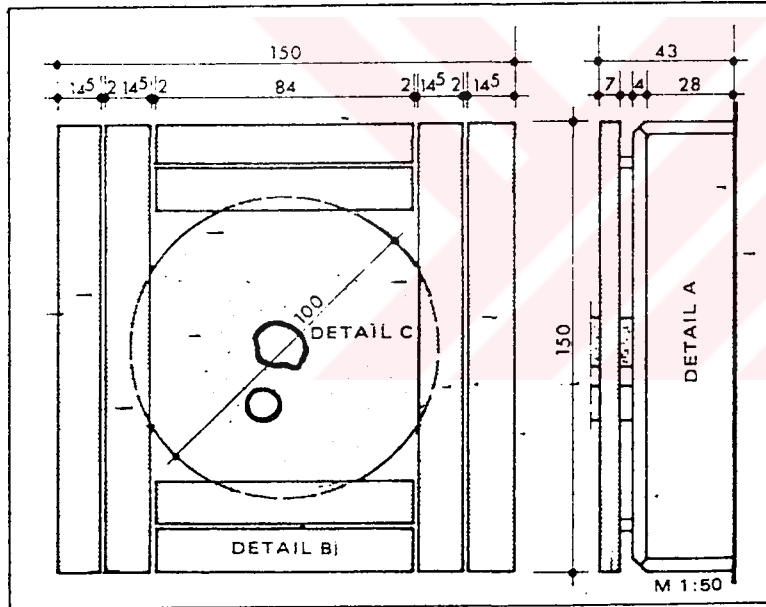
DETAIL A Beton RAL 7030 Steingrau Glatt Gegossen	Concrete Stone gray Polished Casted	Béton Gris pierre Lissé Moulé
